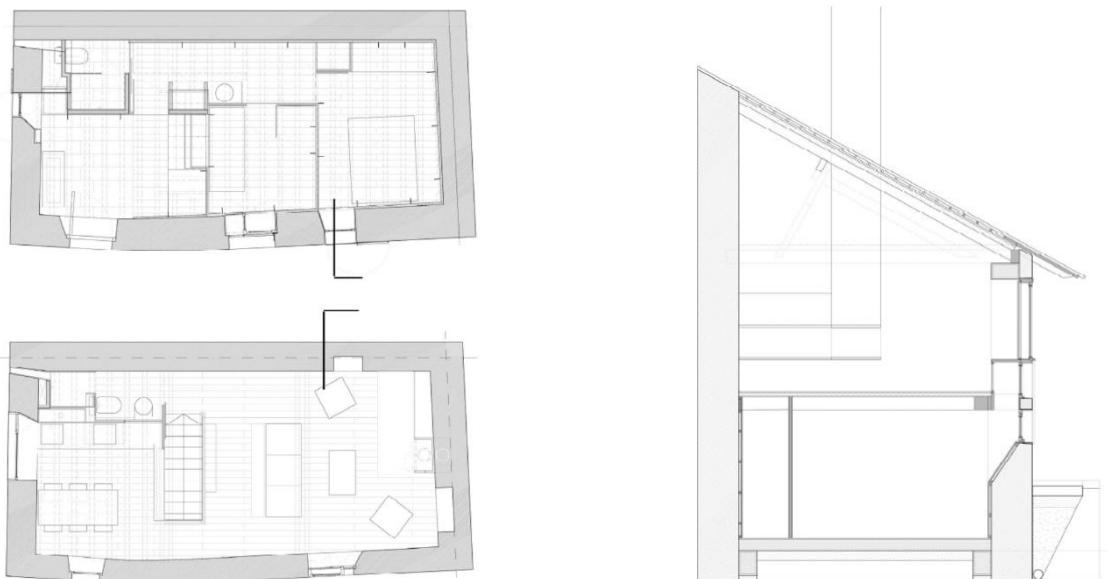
Plantas y sección [Congrés d'Arquitectura 2016]
